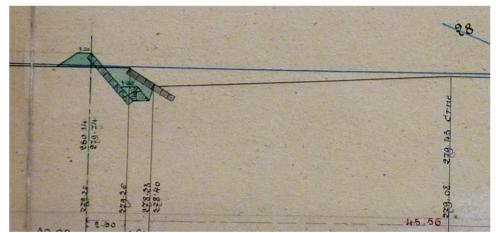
Profil des ouvrages de la Leysse en aval du pont de chemin de fer, 1875 (AD 73 – S 1274)
